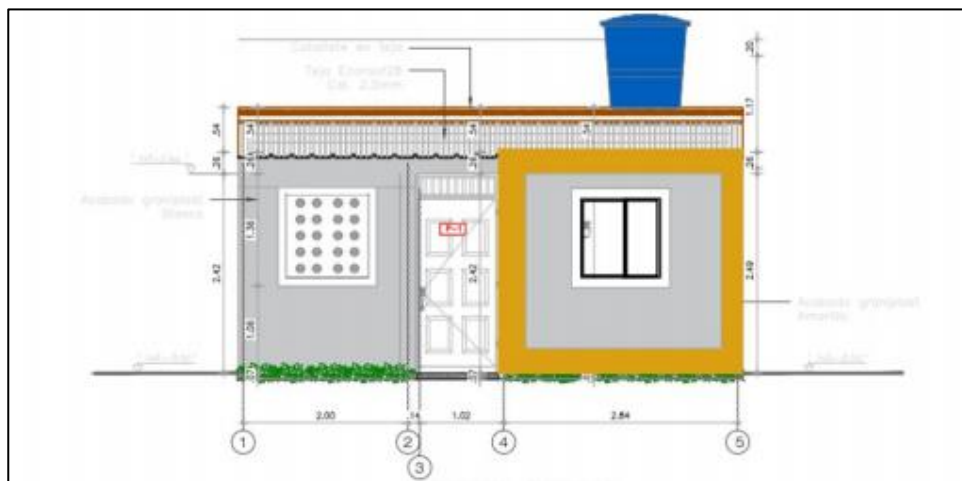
Fachada Principal Vivienda Villa KA'I – Dos ventanas
